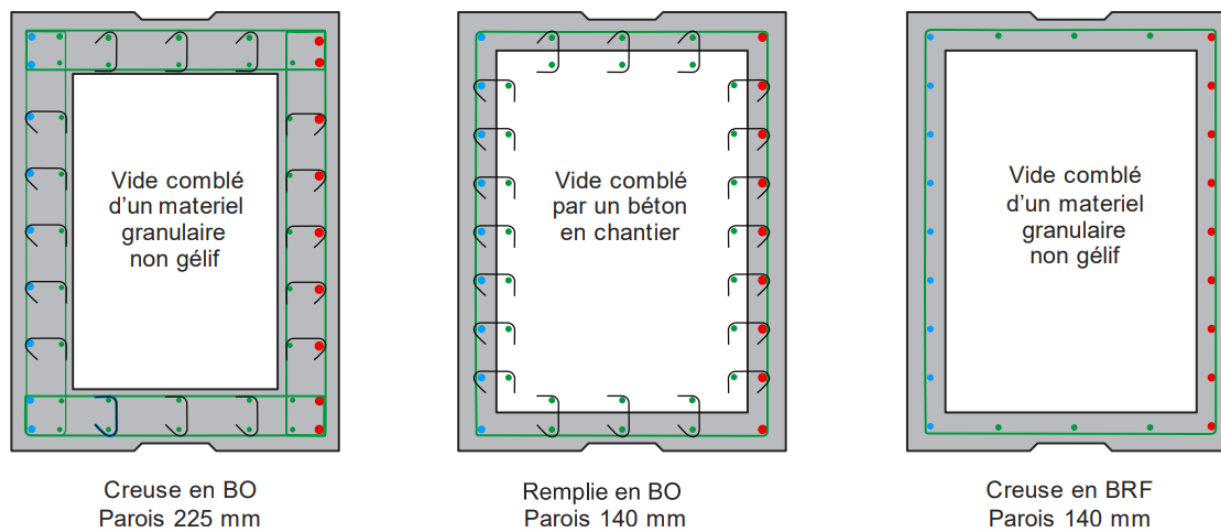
Concepts préliminaires des culées préfabriquées – Vue en plan
